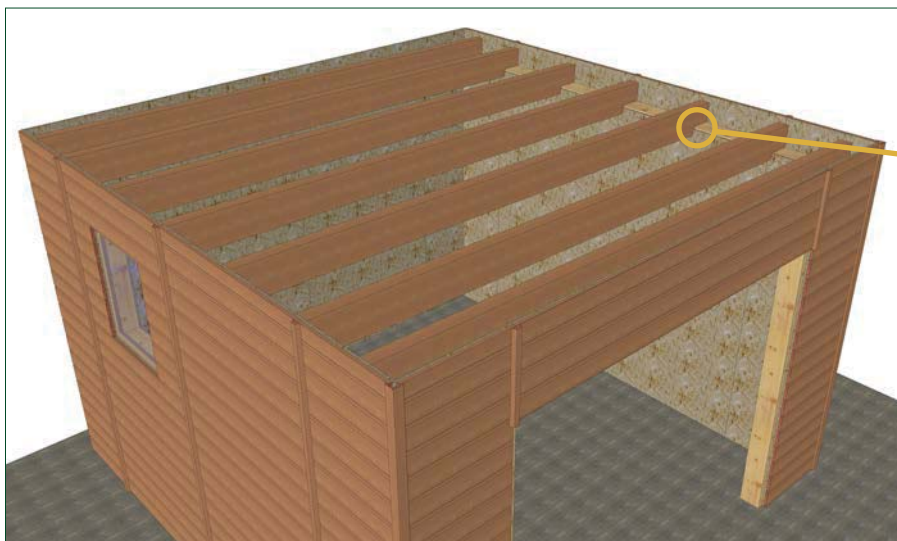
Pose des poutres dans le sens de la largeur de la structure
